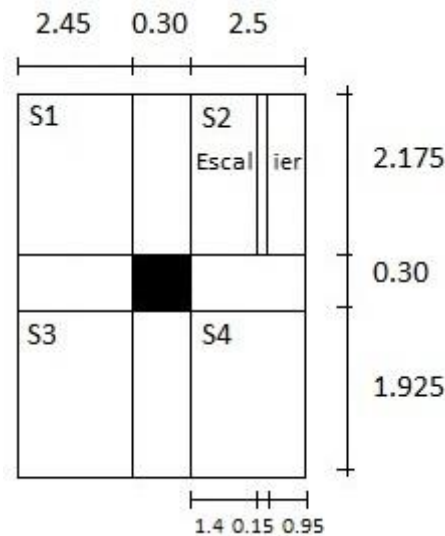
« La section du plancher pour le poteau le plus sollicité »
